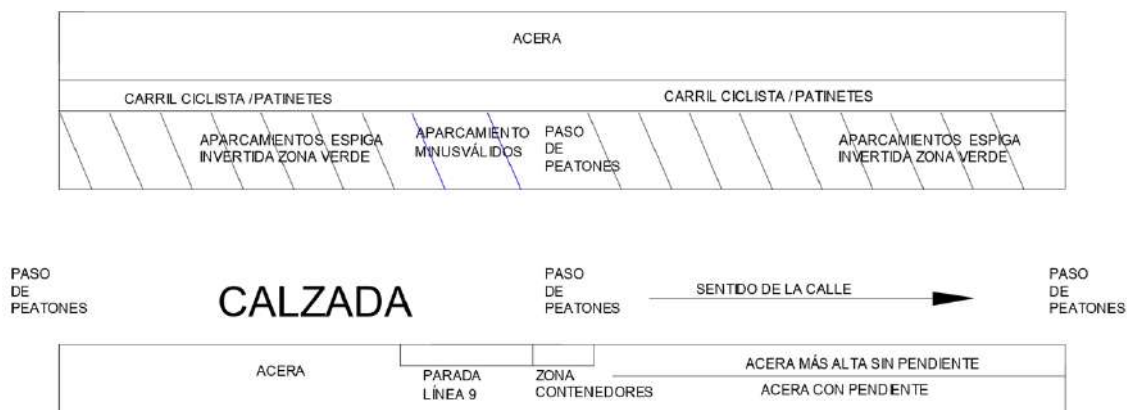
Aproximación de como quedaría la calle en planta. Fuente: Elaboración propia.
